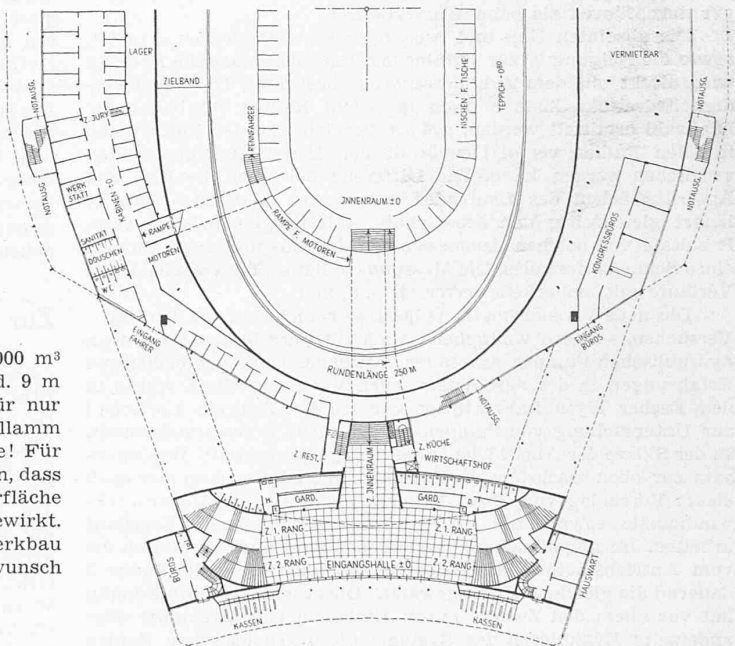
Erdgeschoss der Südhalfte mit Eingängen. — 1 : 1000
